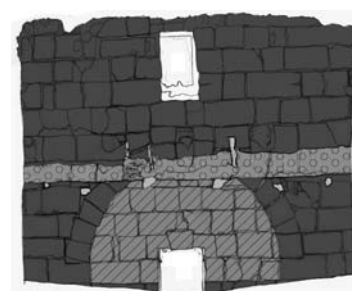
Rekonstruktionsversuch der ursprünglichen Holzdecke, 2006.
